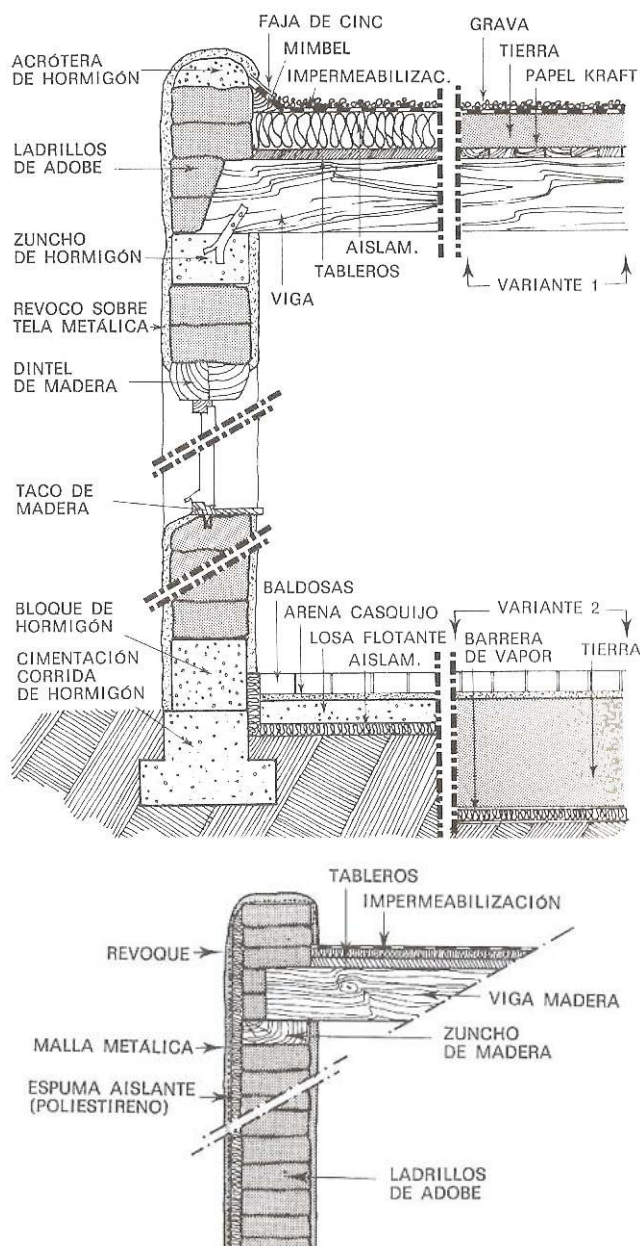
La cimentación y el zócalo también pueden resolverse con hormigón, aunque el precio siempre será más caro y la técnica menos apropiada para autoconstrucción.
